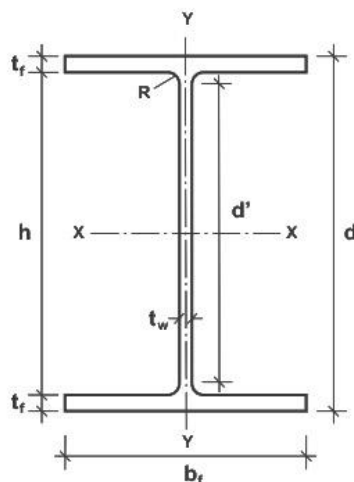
Principais dimensões do perfil metálico I. (Fonte: ABNT (2008))
